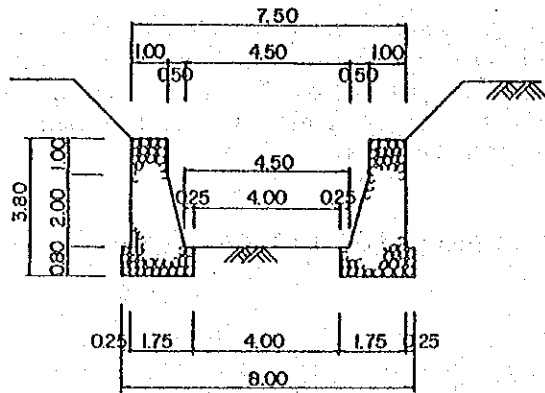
SECCION TRANSVERSAL DE OBRAS DE MEJORAMIENTO EN EJECUCION
